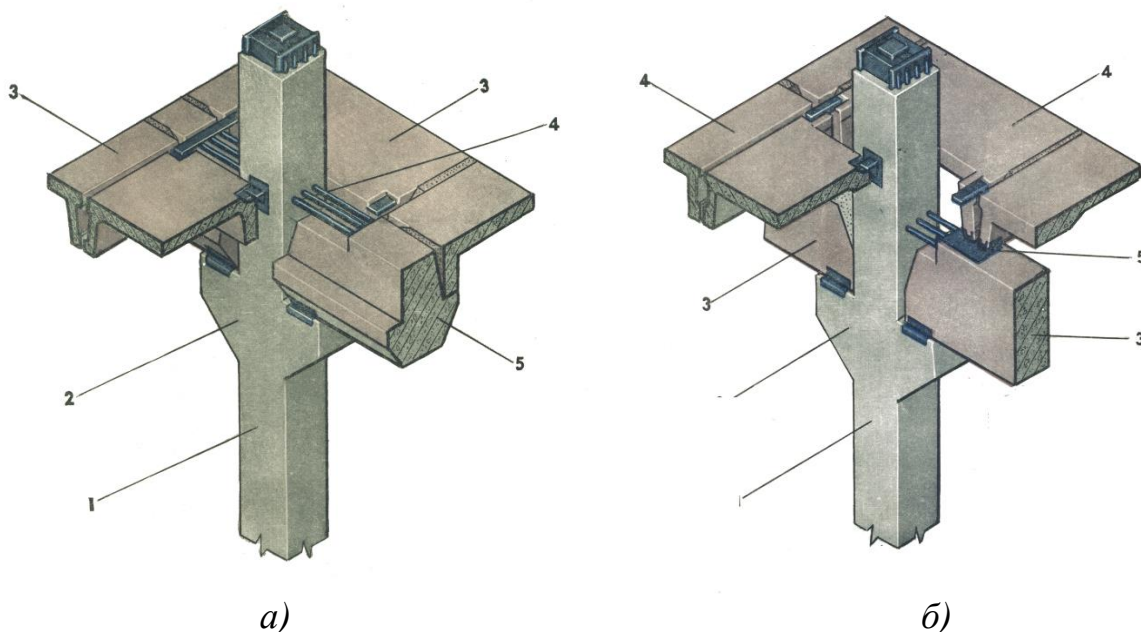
З'єднання залізобетонних колон з конструкціями перекриття:
